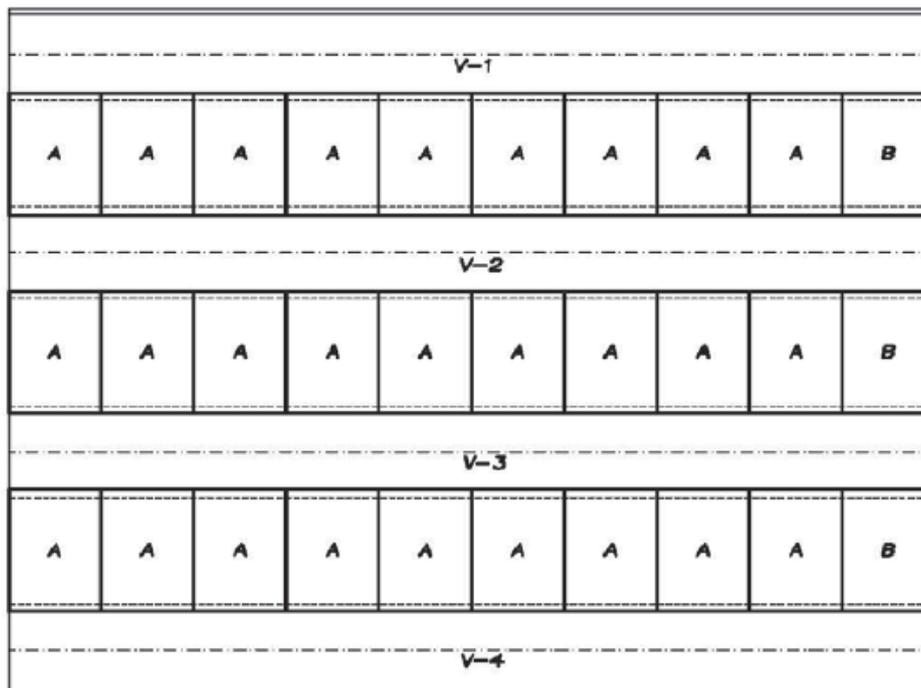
Planta de las placas de encofrado perdido tipo A y B que se colocarán como unión de las vigas prefabricadas.
